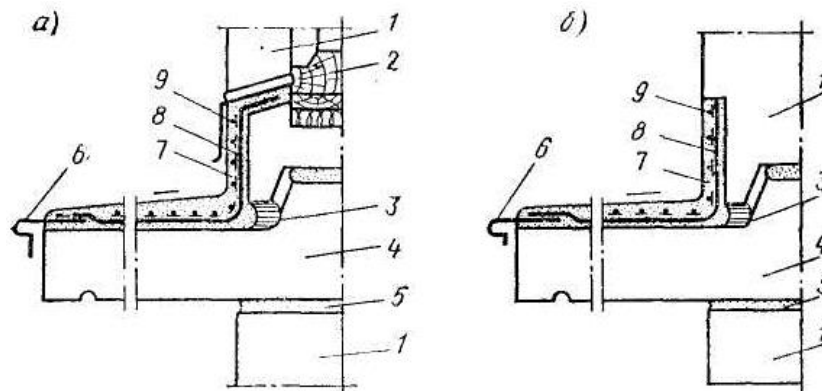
Примыкание балконной плиты к наружной стеновой панели
